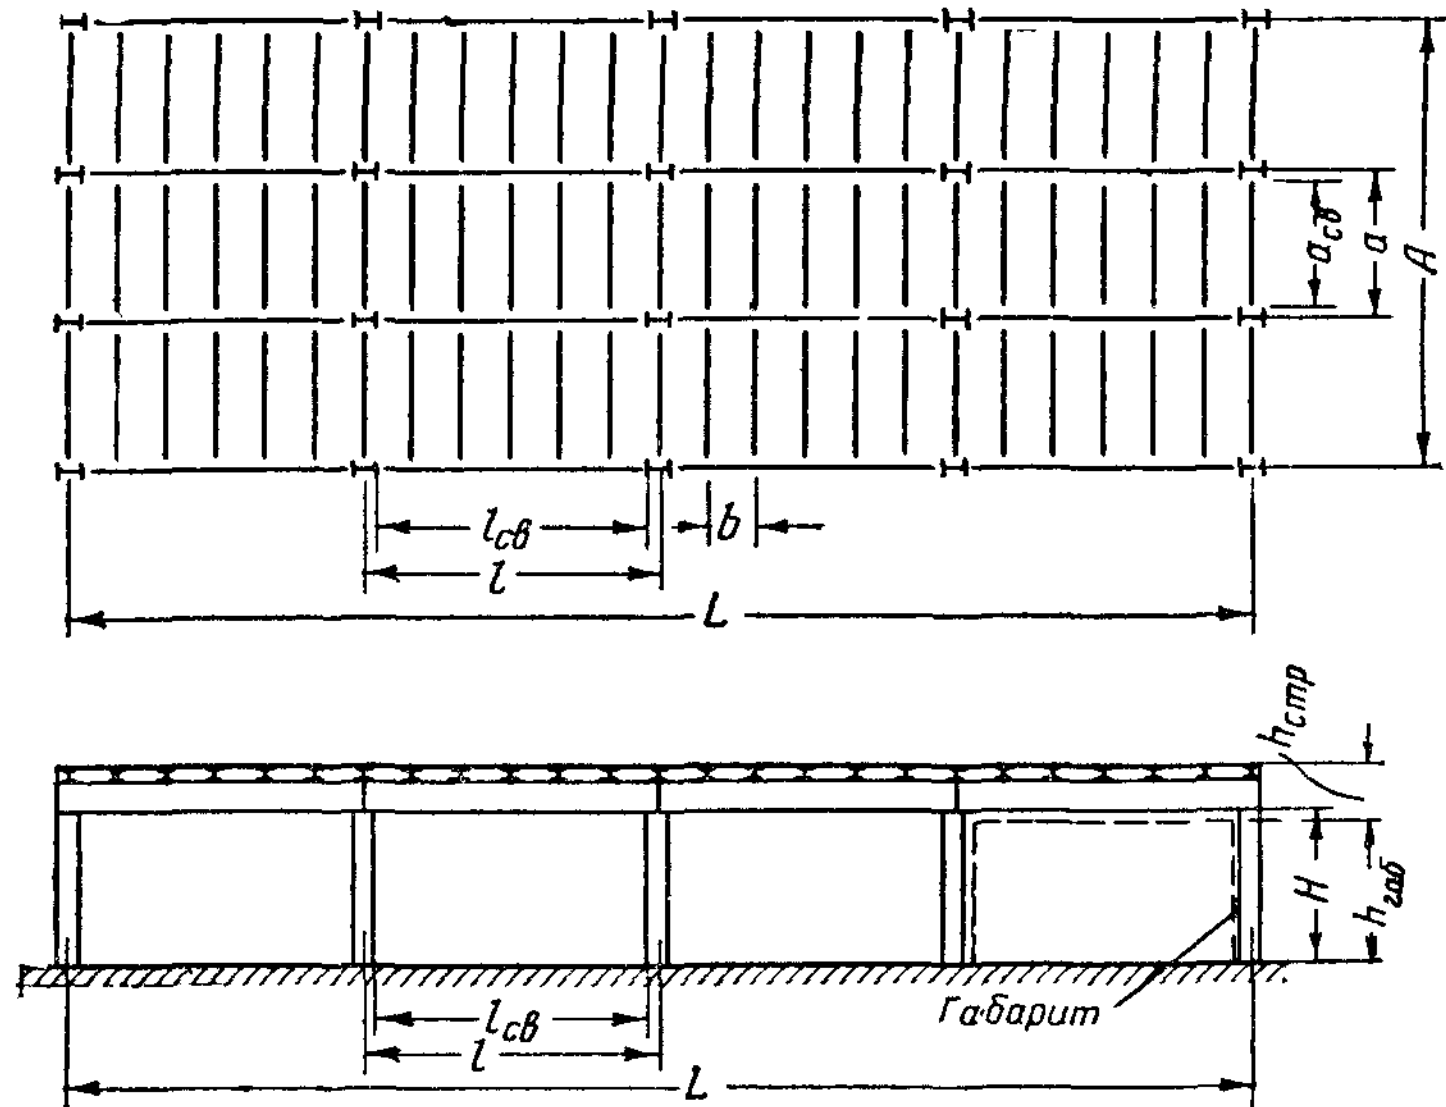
Генеральные размеры перекрытия балочной клетки
